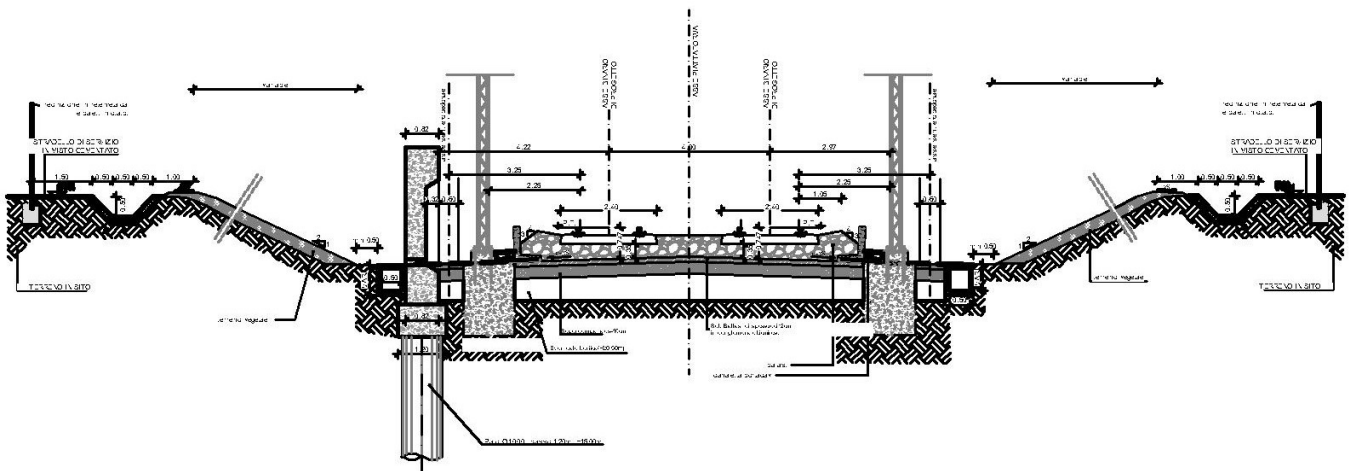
sezione tipo trincea con muro di recinzione in affiancamento in assenza di esercizio
